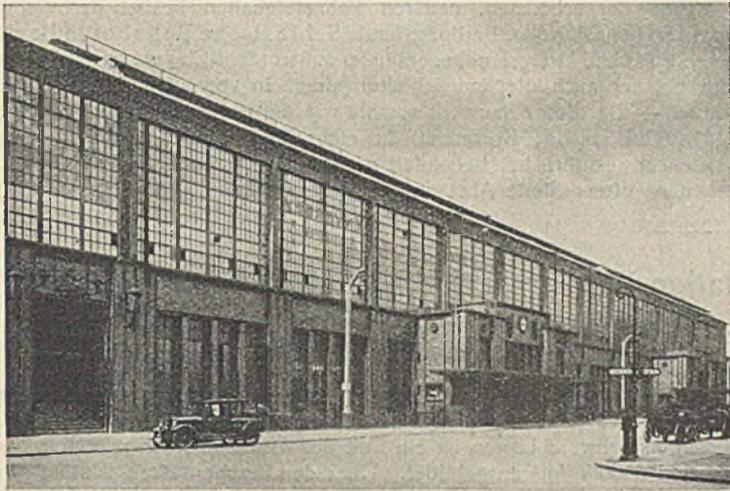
Bahnhof Berlin Friedrichstraße. Äußere Seitenansicht.
